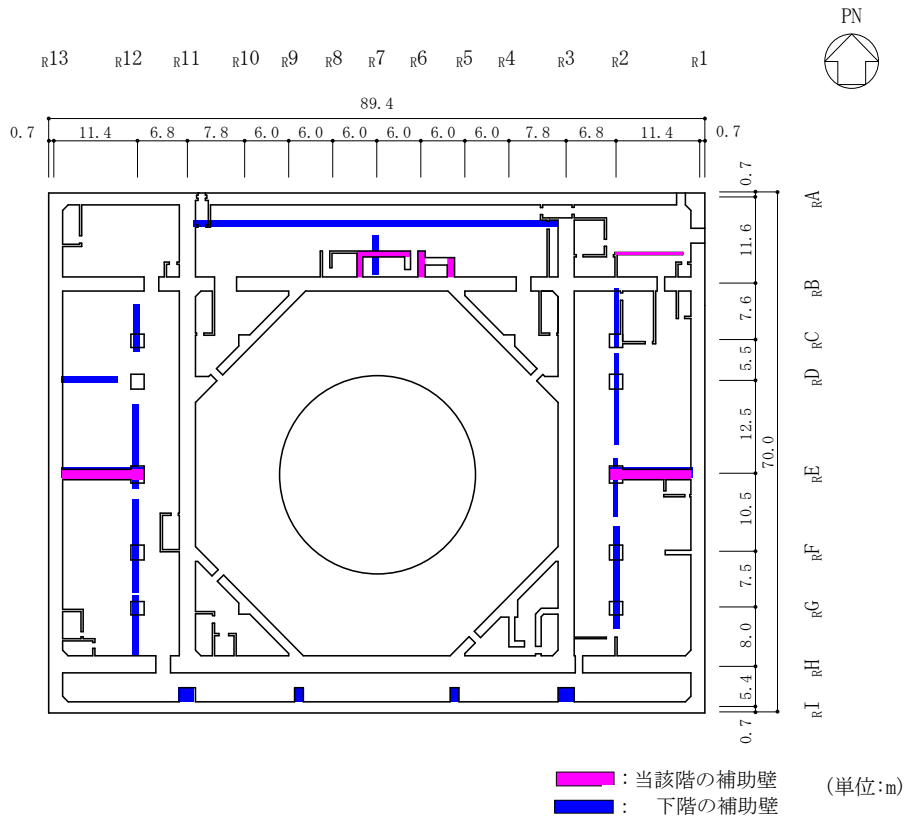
(1) 補助壁の配置図 (EL 8.8m)
